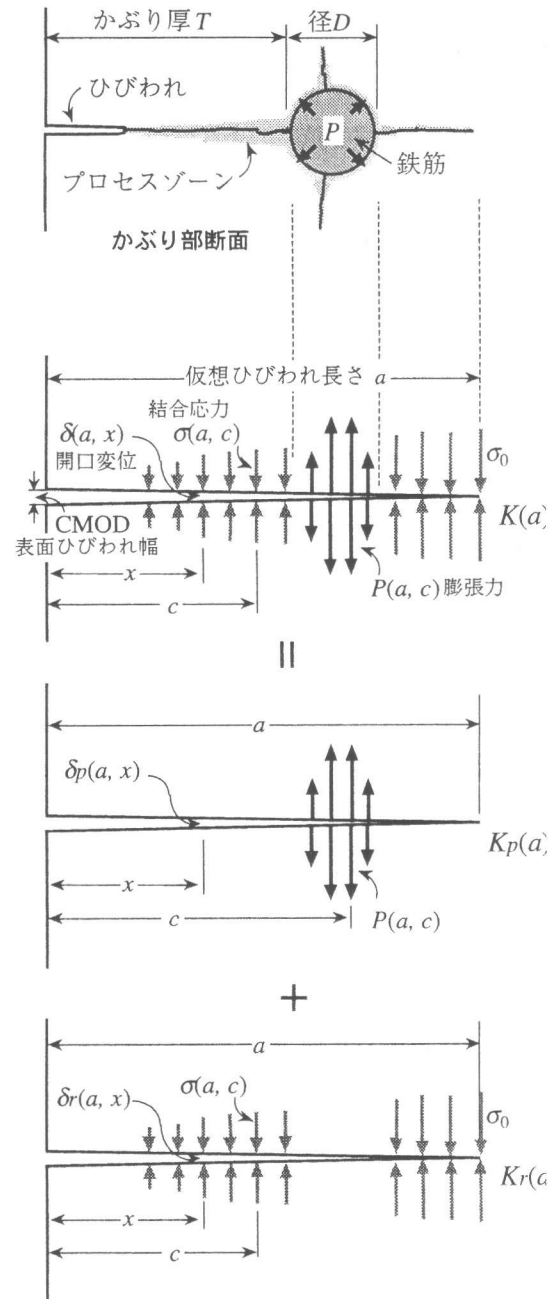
鉄筋膨張によるひびわれ進展のモデル化
